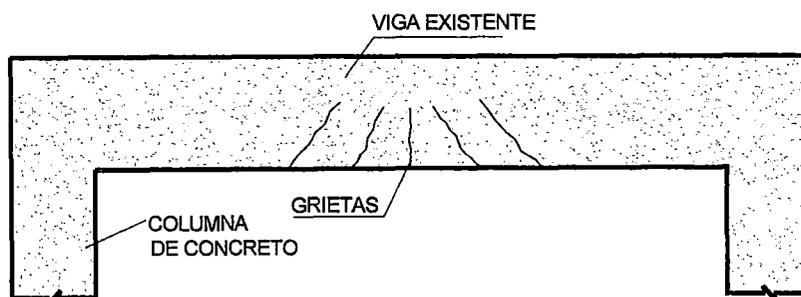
Grietas por el alargamiento del acero del refuerzo positivo.
